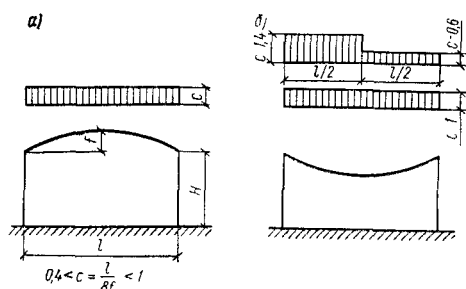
Схемы снеговой нагрузки на покрытия
